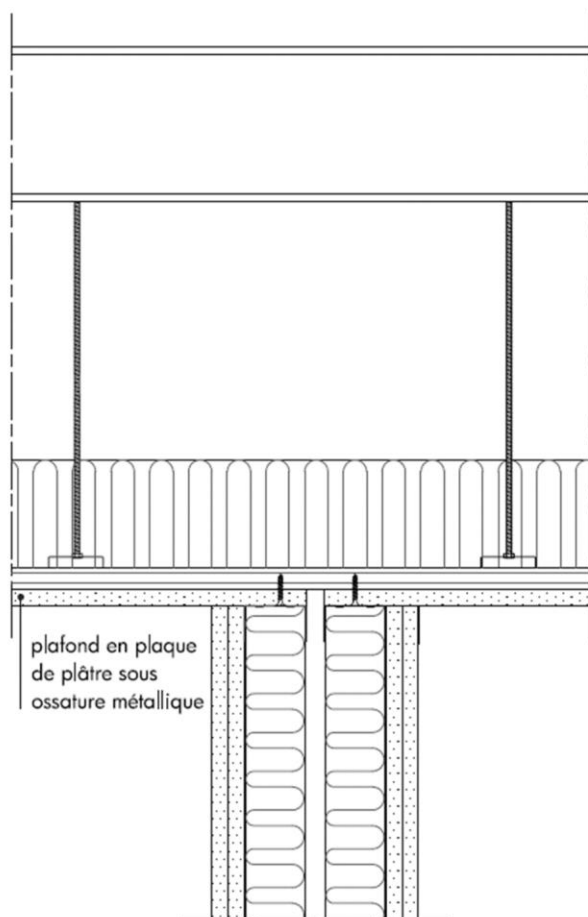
Principe de raccordement d'une cloison séparative KMA sous un plafond plaques de plâtre sous ossature
